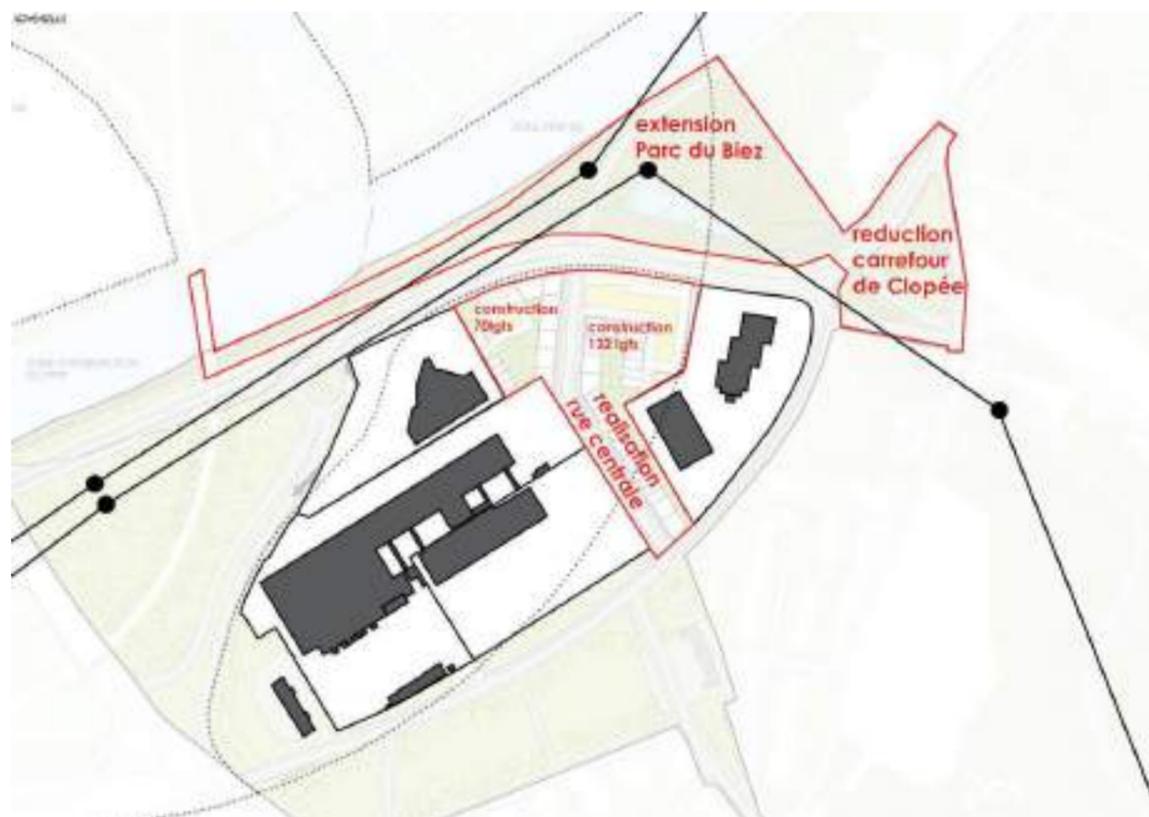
Phase 1 – Site Cœur Calix à Mondeville (source : Plan Guide MVRDV)
